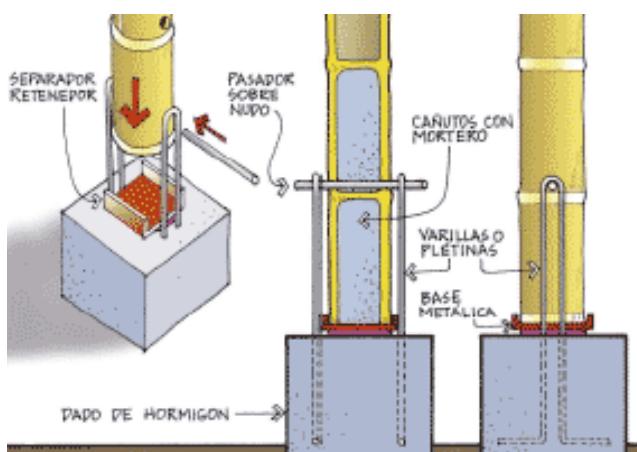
Fuente página de internet arquba, cimentación con bambú y concreto.
